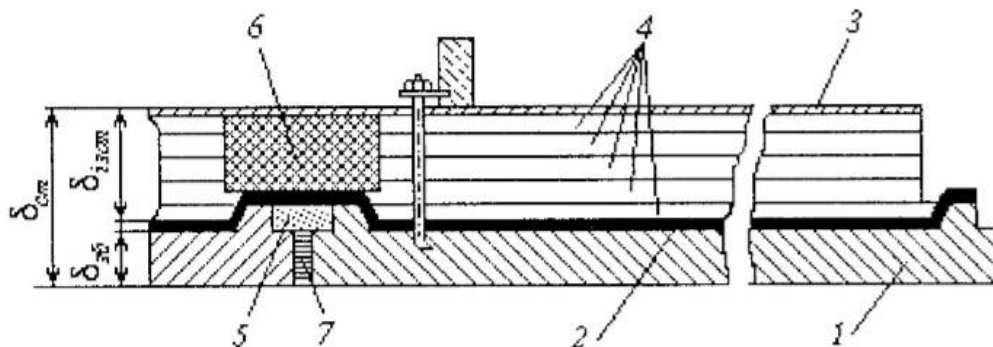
Конструкція збірних стінових вертикальних ізольованих панелей багатопверхових холодильників і кріплення до між етажного залізобетонного перекриття (вид зверху): т – залізобетонна плита; 2 – пароізоляція (холодна бітумна ґрунтовка і шар пластифіцированого боруліна на гарячій бітумній мастиці); 3 – азбоцементний пресований лист ($\delta_a = 8$ мм); 4 – мінеральна пробка загальною товщиною 300 мм; 5 – бетон; 6 – більш ефективний, чим основний, теплоізоляційний матеріал; 7 – закладення шва цементним розчином.
